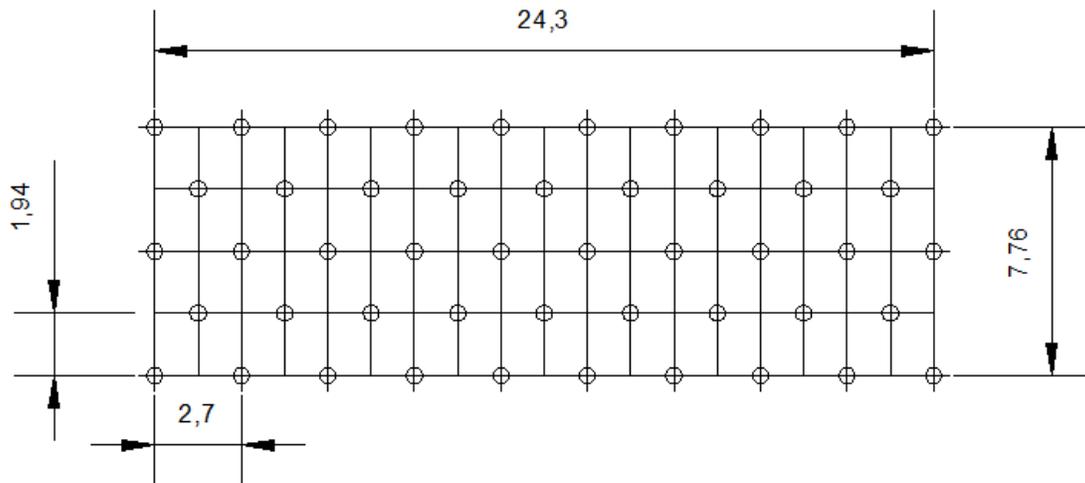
Propuesta de la nueva plantilla de barrenación, tresbolillo.
